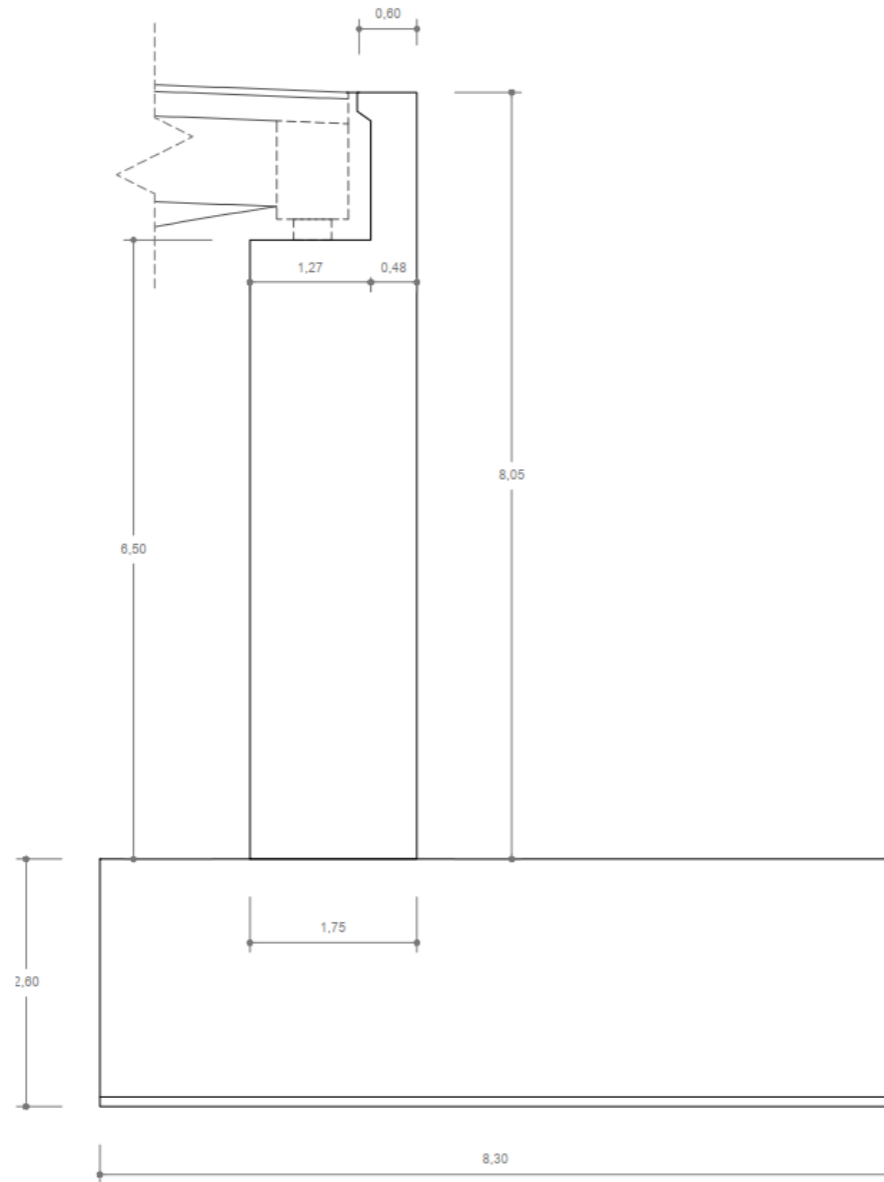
Vista en alzado de los estribos con las zapatas (fuente: elaboración propia)
